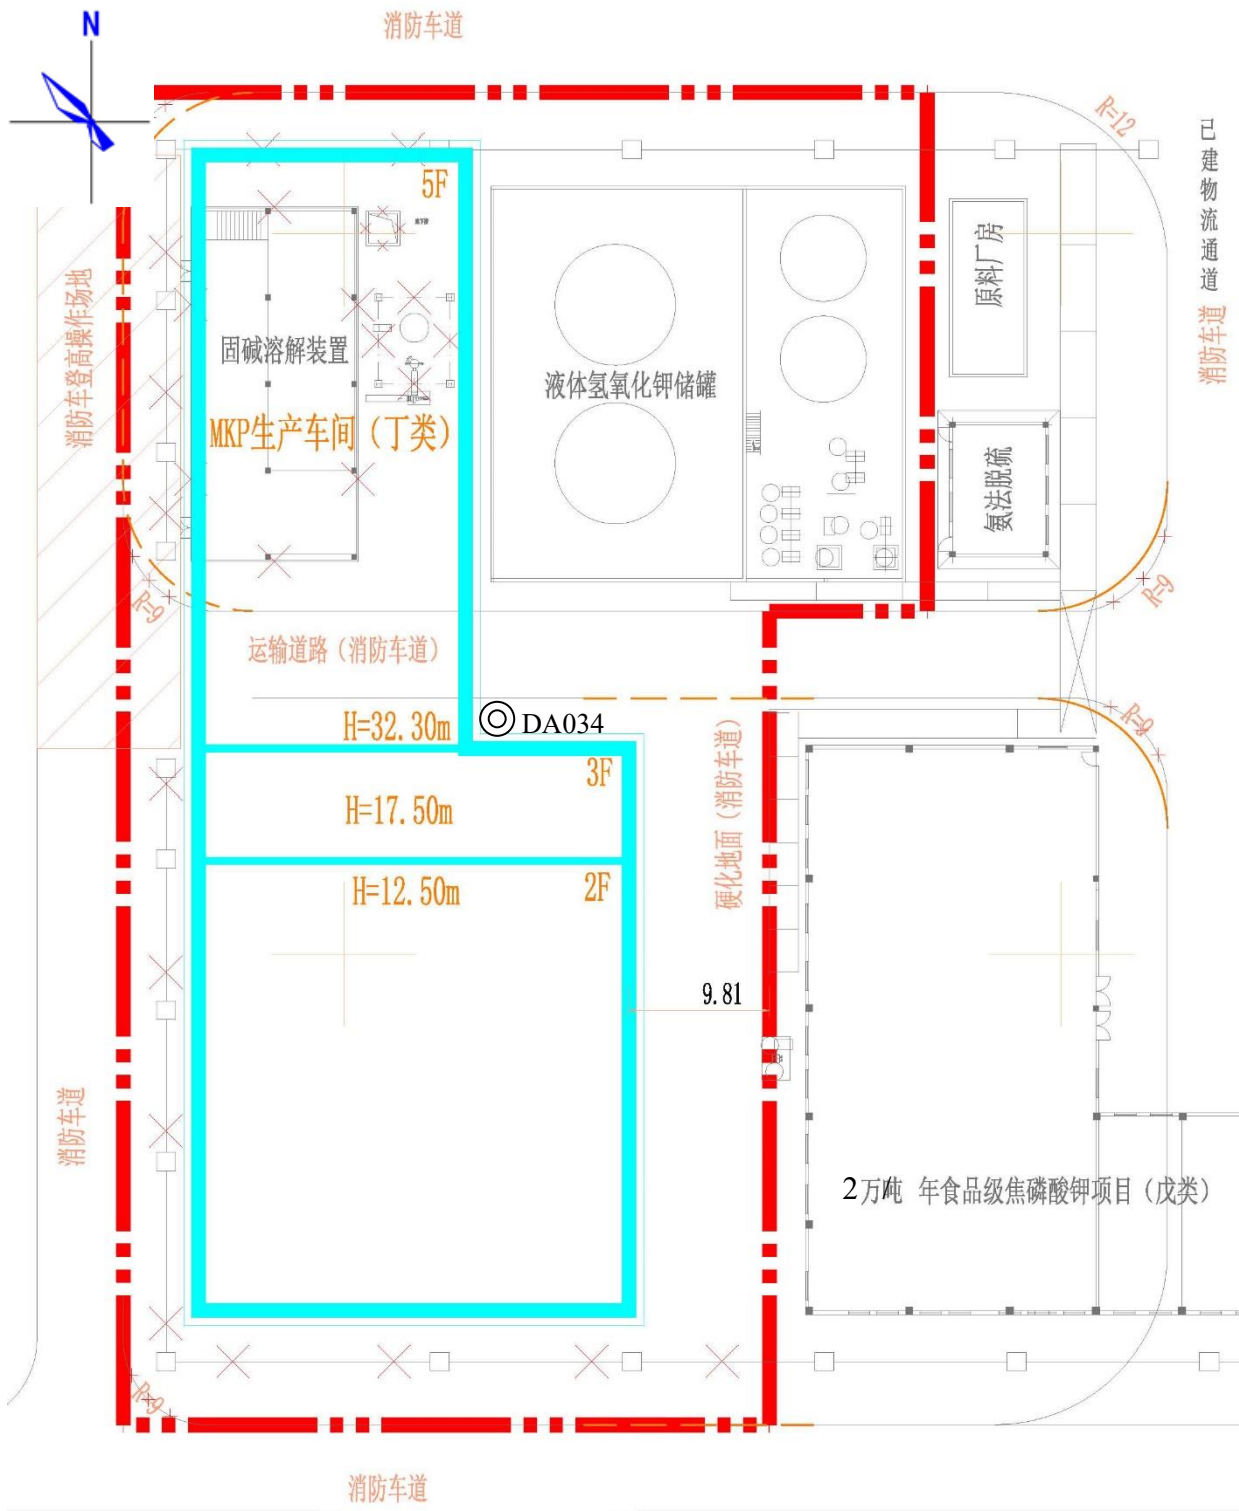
5万吨/年MAP/MKP多功能装置区平面图
